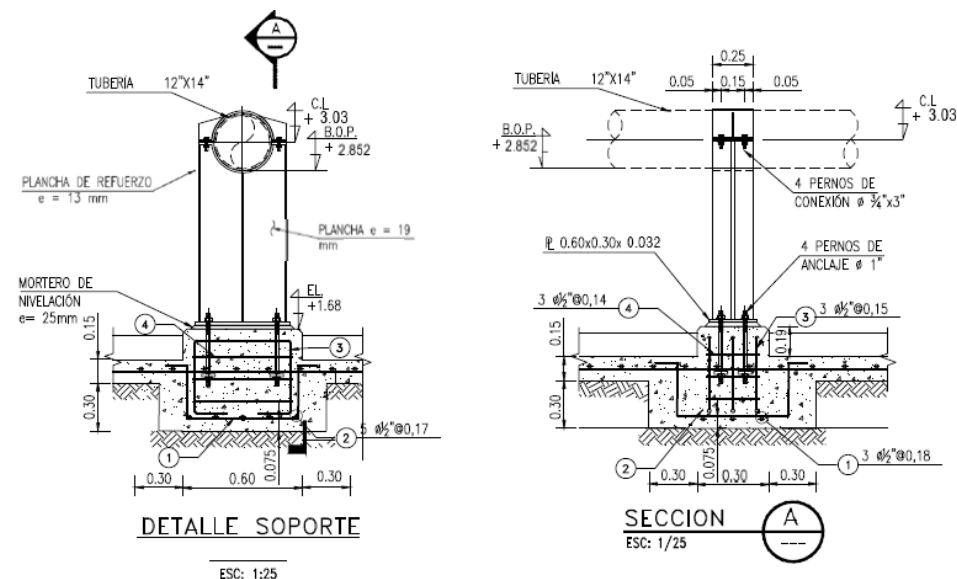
Detalle típico de un soporte metálico de tubería mixta
